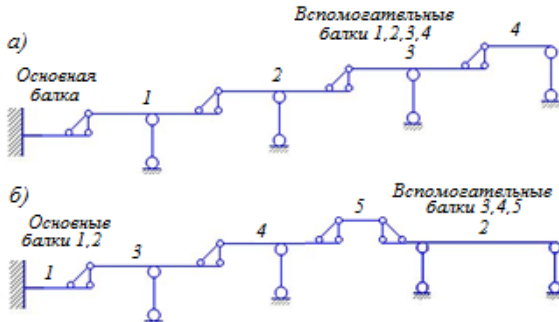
Поэтажные схемы шарнирных балок с одной жесткой опорой
